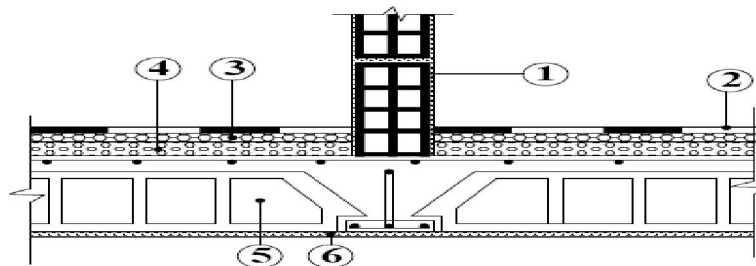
Coupe verticale d'un plancher étage courant (corps creux).
